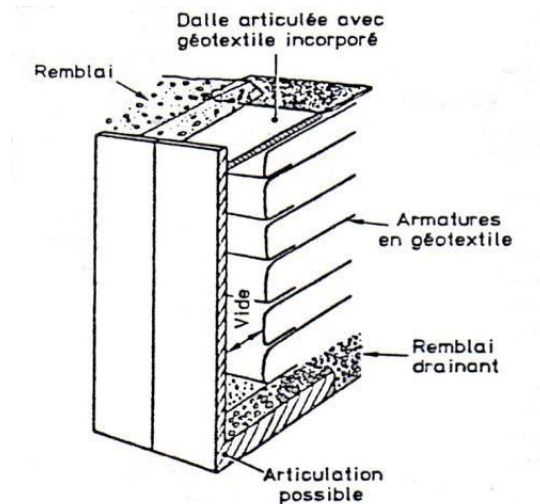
Profil en travers d'un mur renforcé par géotextiles.
